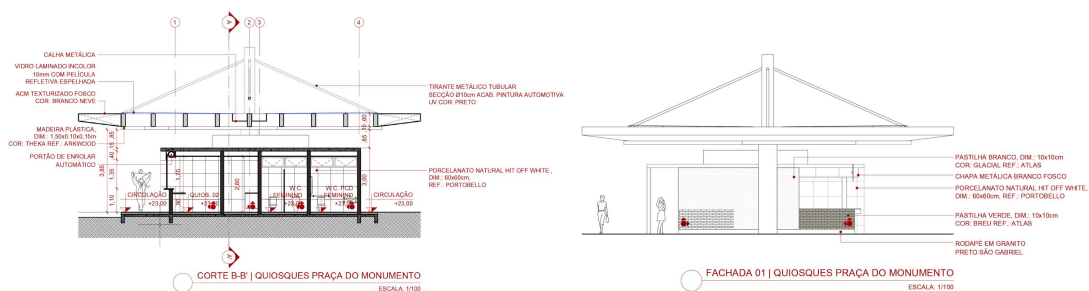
Executivo Quiosques da Praça do Barco: Elevações e Cortes - SketchUp
